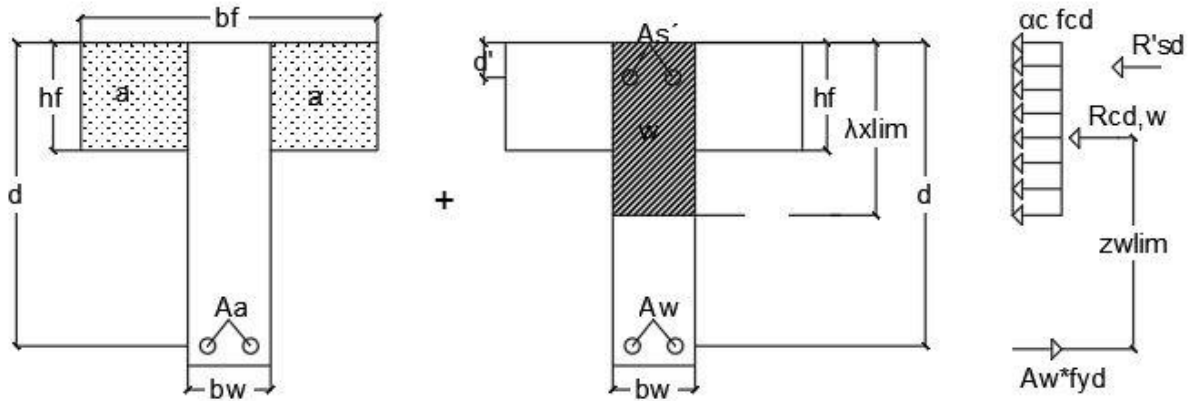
Armaduras seção T (Elaborado pela autora, 2018)
